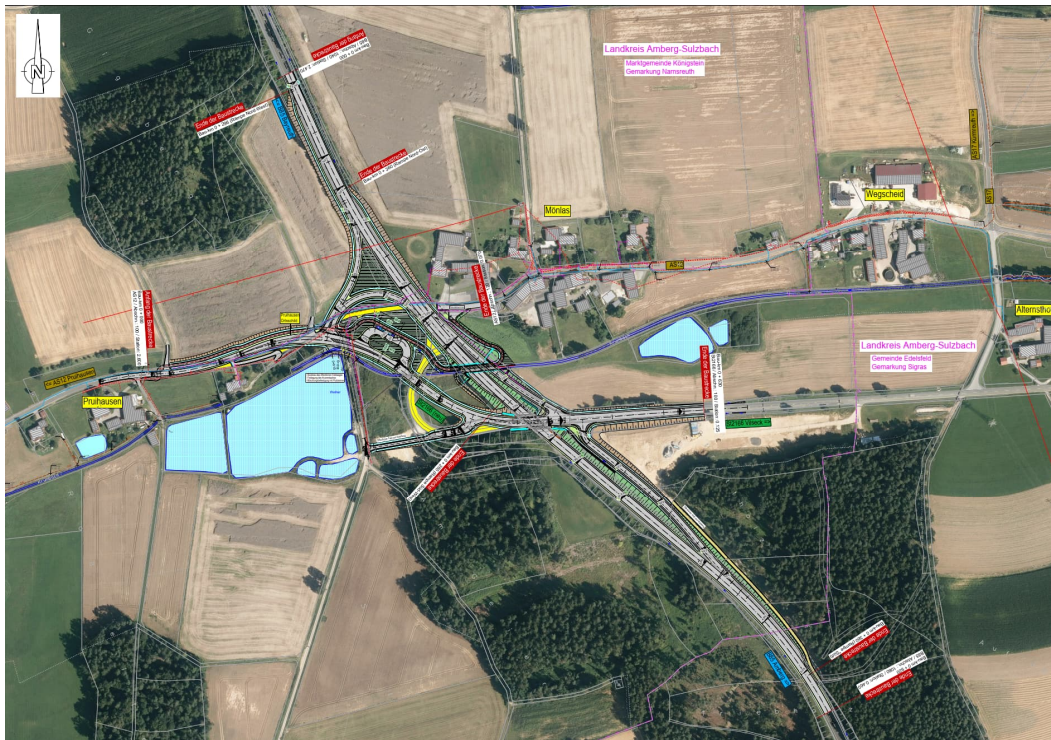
Lageplan "Variante 5" (Eigenplanung: Staatliches Bauamt Amberg-Sulzbach)
